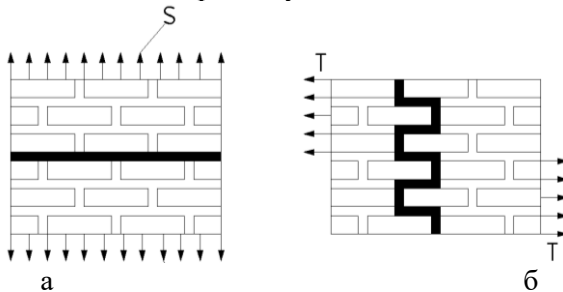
Схеми руйнування розтягнутої кладки: а – за неперев'язаним швом; б – за перев'язаним швом
